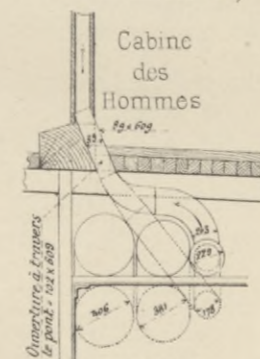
Coupe transversale CD dans les conduits d'aérag. (Echelle C.)
